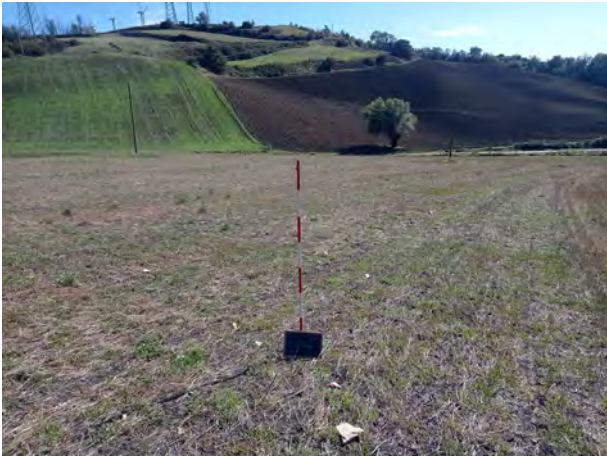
cavidotto MTZ 2 – MTZ2 vista da O.
